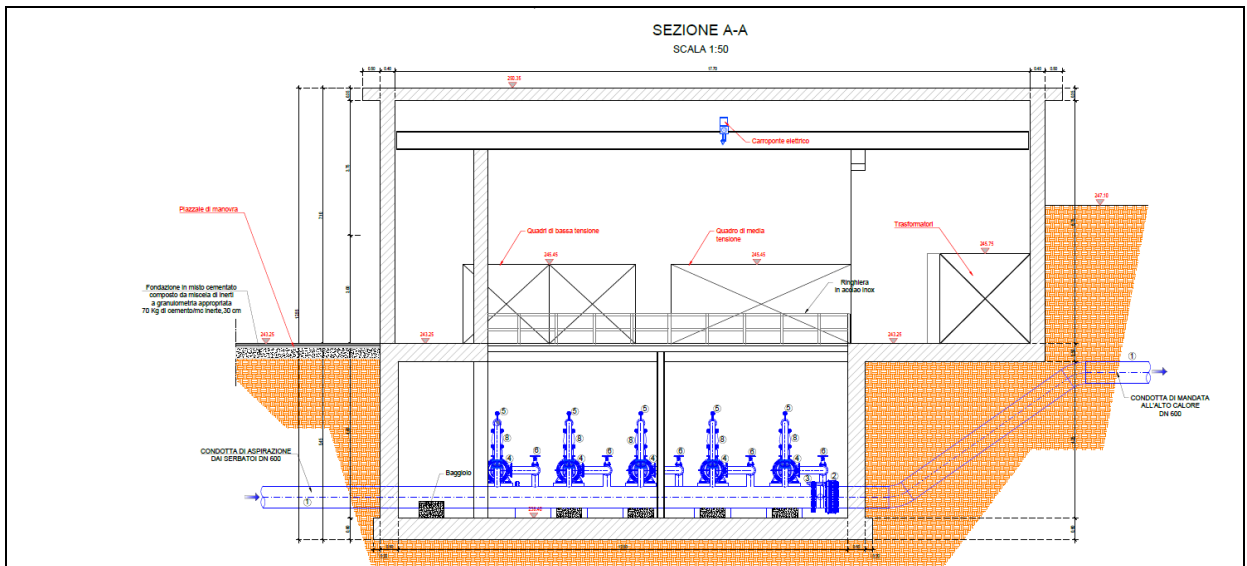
Sezioni tipo Impianto di Sollevamento
